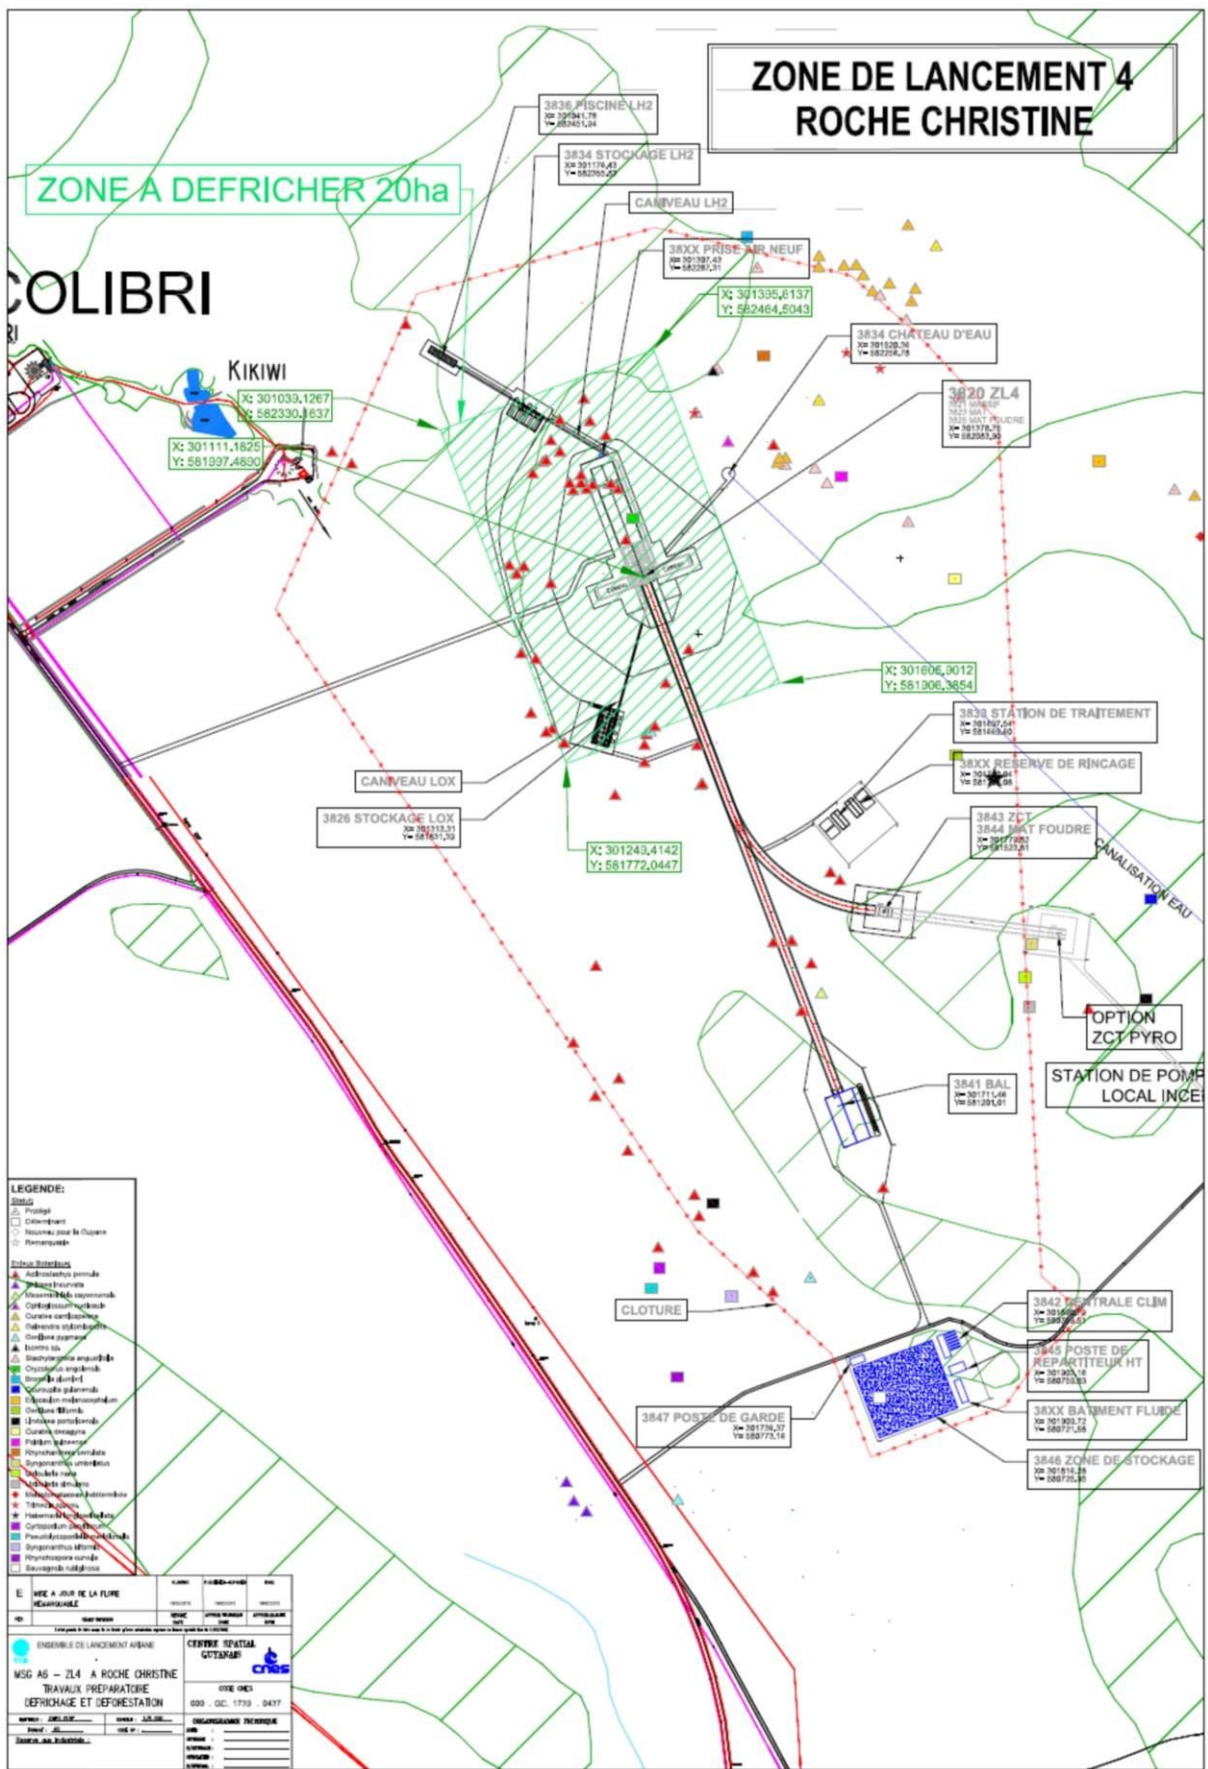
Plan masse des installations pour les ELA 4 et le BAL (Source CNES)
